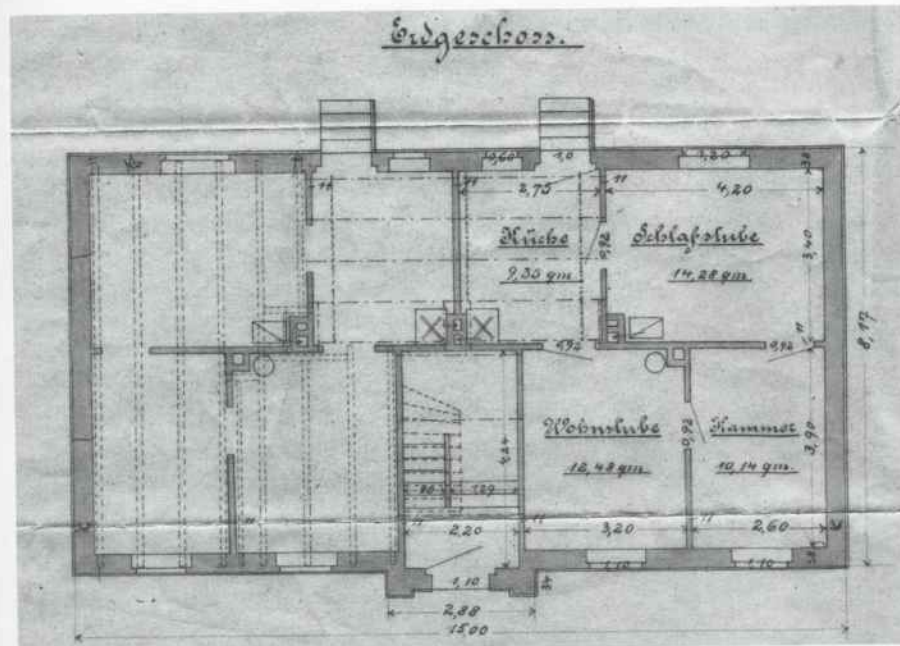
Alsenkamp 8, Grundriss Erdgeschoss 1901
